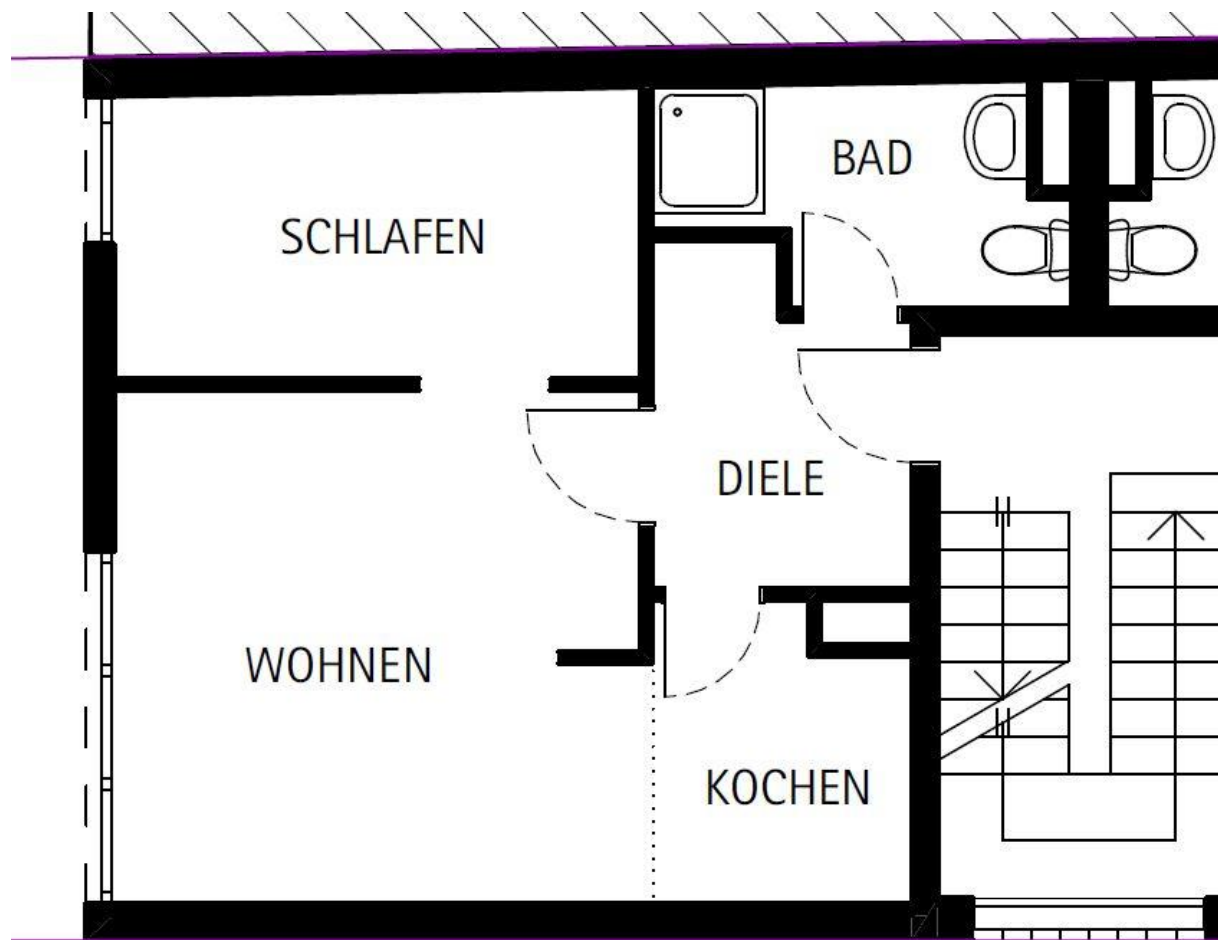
maßstäblicher Grundriss – Wohnung
